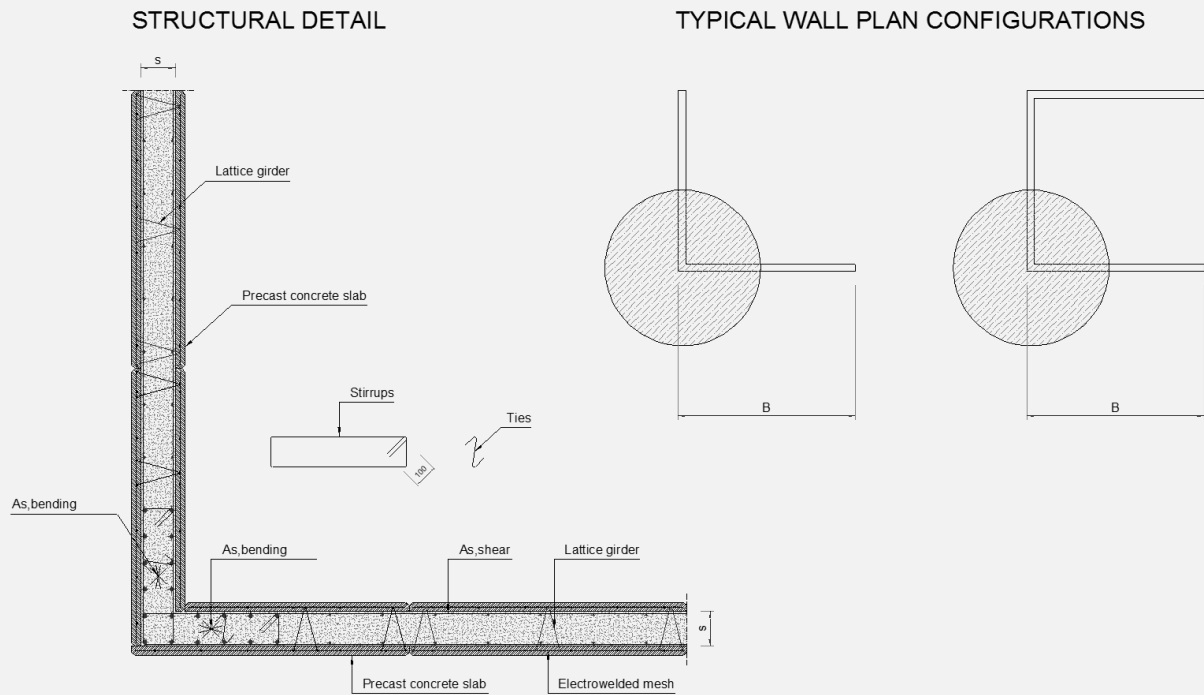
Detaliu structural tipic de colț pentru sistem de pereți din b.a. pentru contravântuire și dispunere în plan tipică (vedere de sus).
